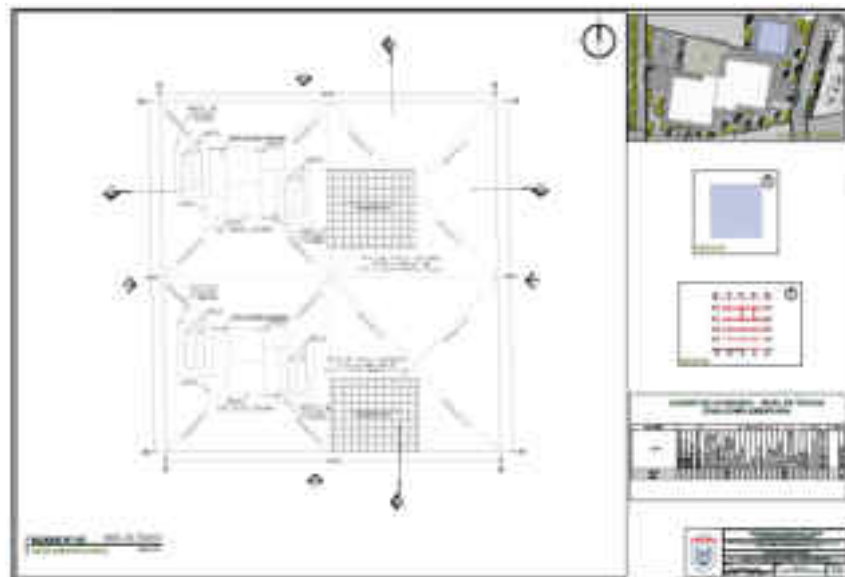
Planimetría del nivel de techos – bloque N° 03
